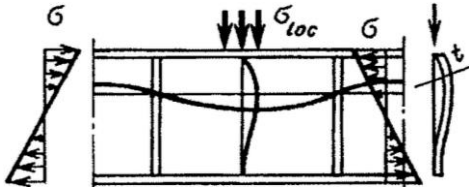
Местная потеря устойчивости стенки балки под наиболее нагруженным опорным колесом крана
